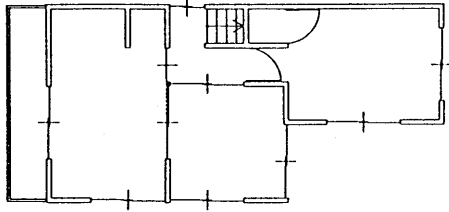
解析対象建築物平面図 (No.25, No.26)
